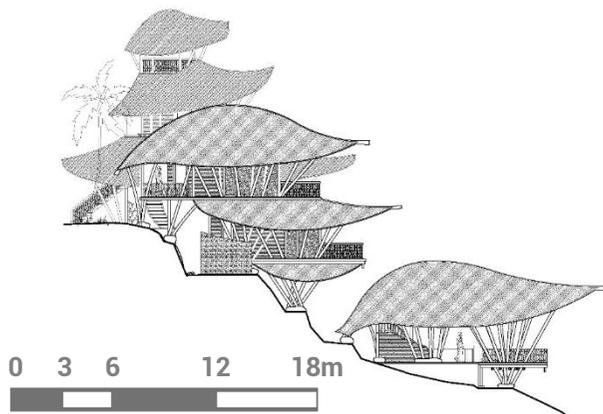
Expressão da proposta arquitetônica decorrente da implantação.
